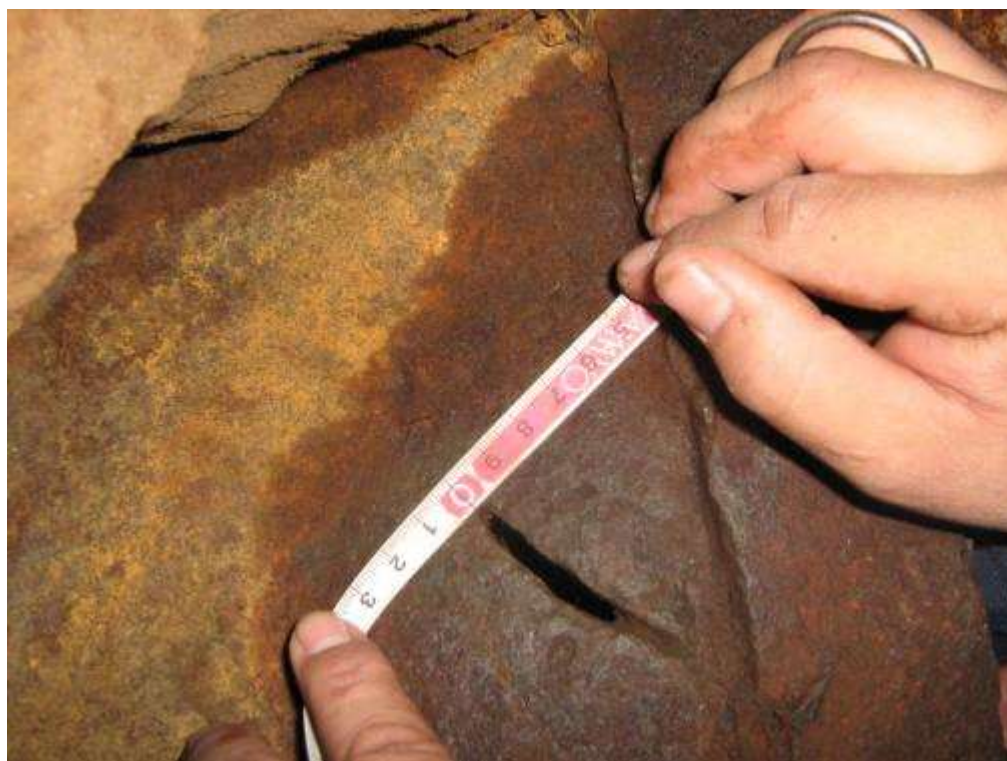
Трещина с наружной стороны дна резервуара
